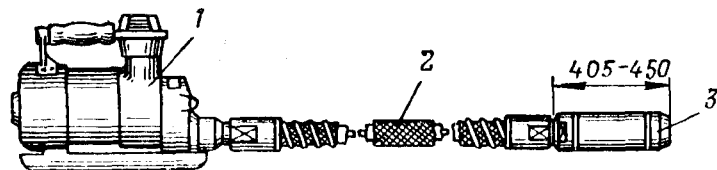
Глубинный вибратор с гибким валом И-21А:
